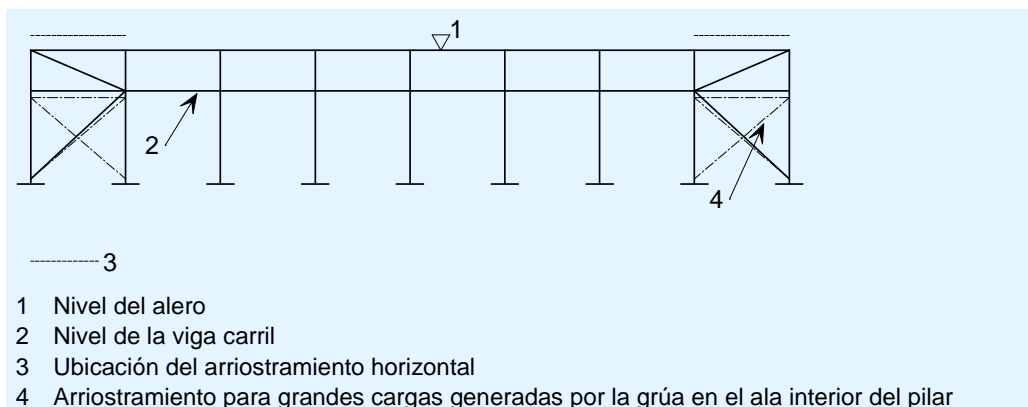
Alzado donde se muestra la ubicación del arriostramiento adicional en el plano de la viga carril
